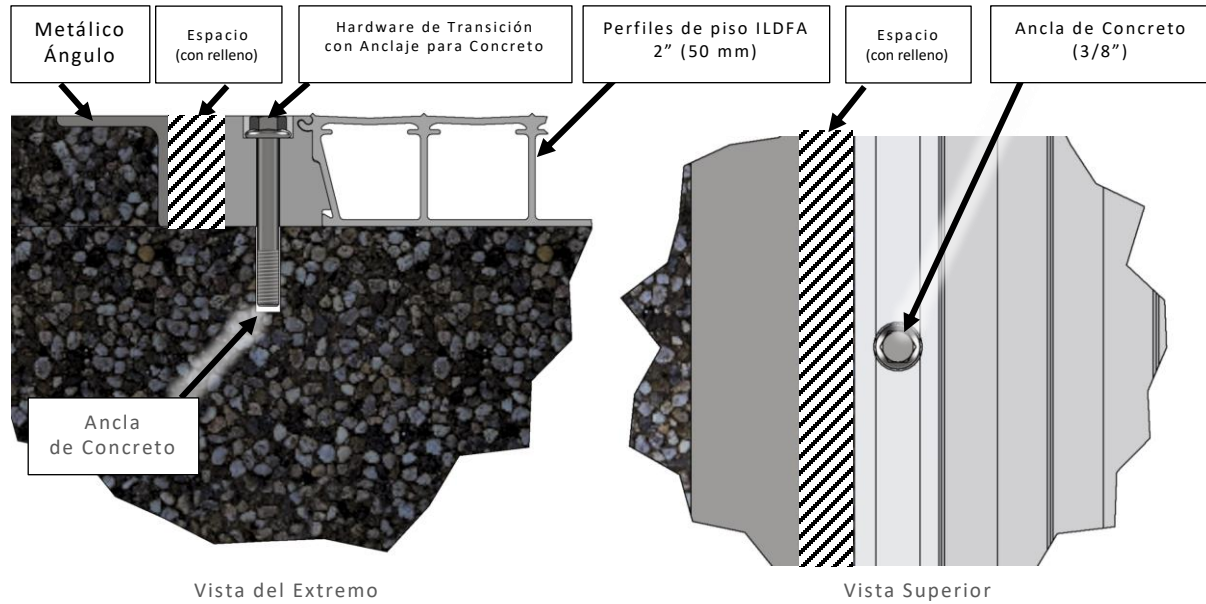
Transición de la Losa del Hangar al ILDFA con Concreto Empotrado
